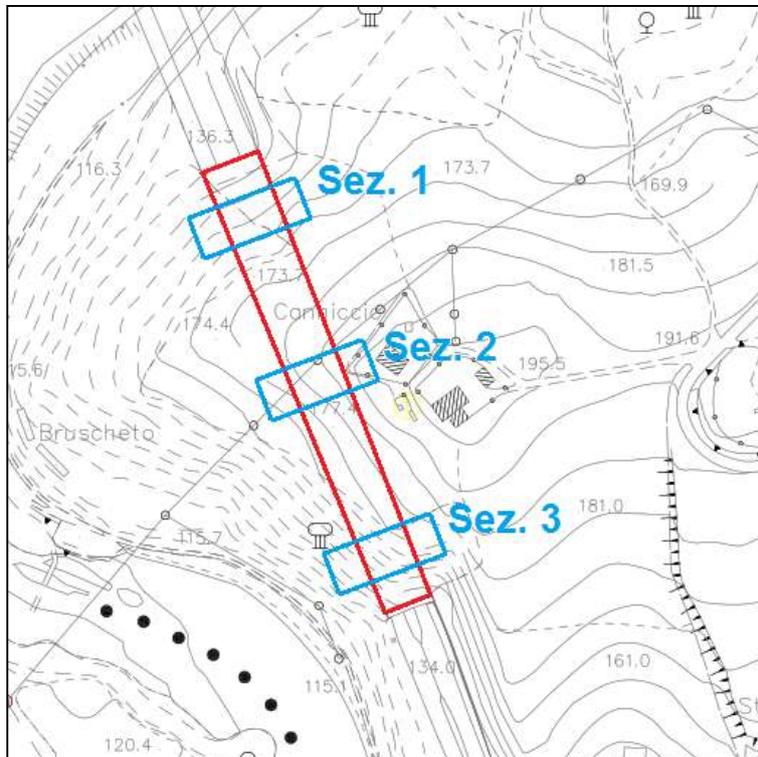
Ubicazione indicativa delle sezioni della galleria
